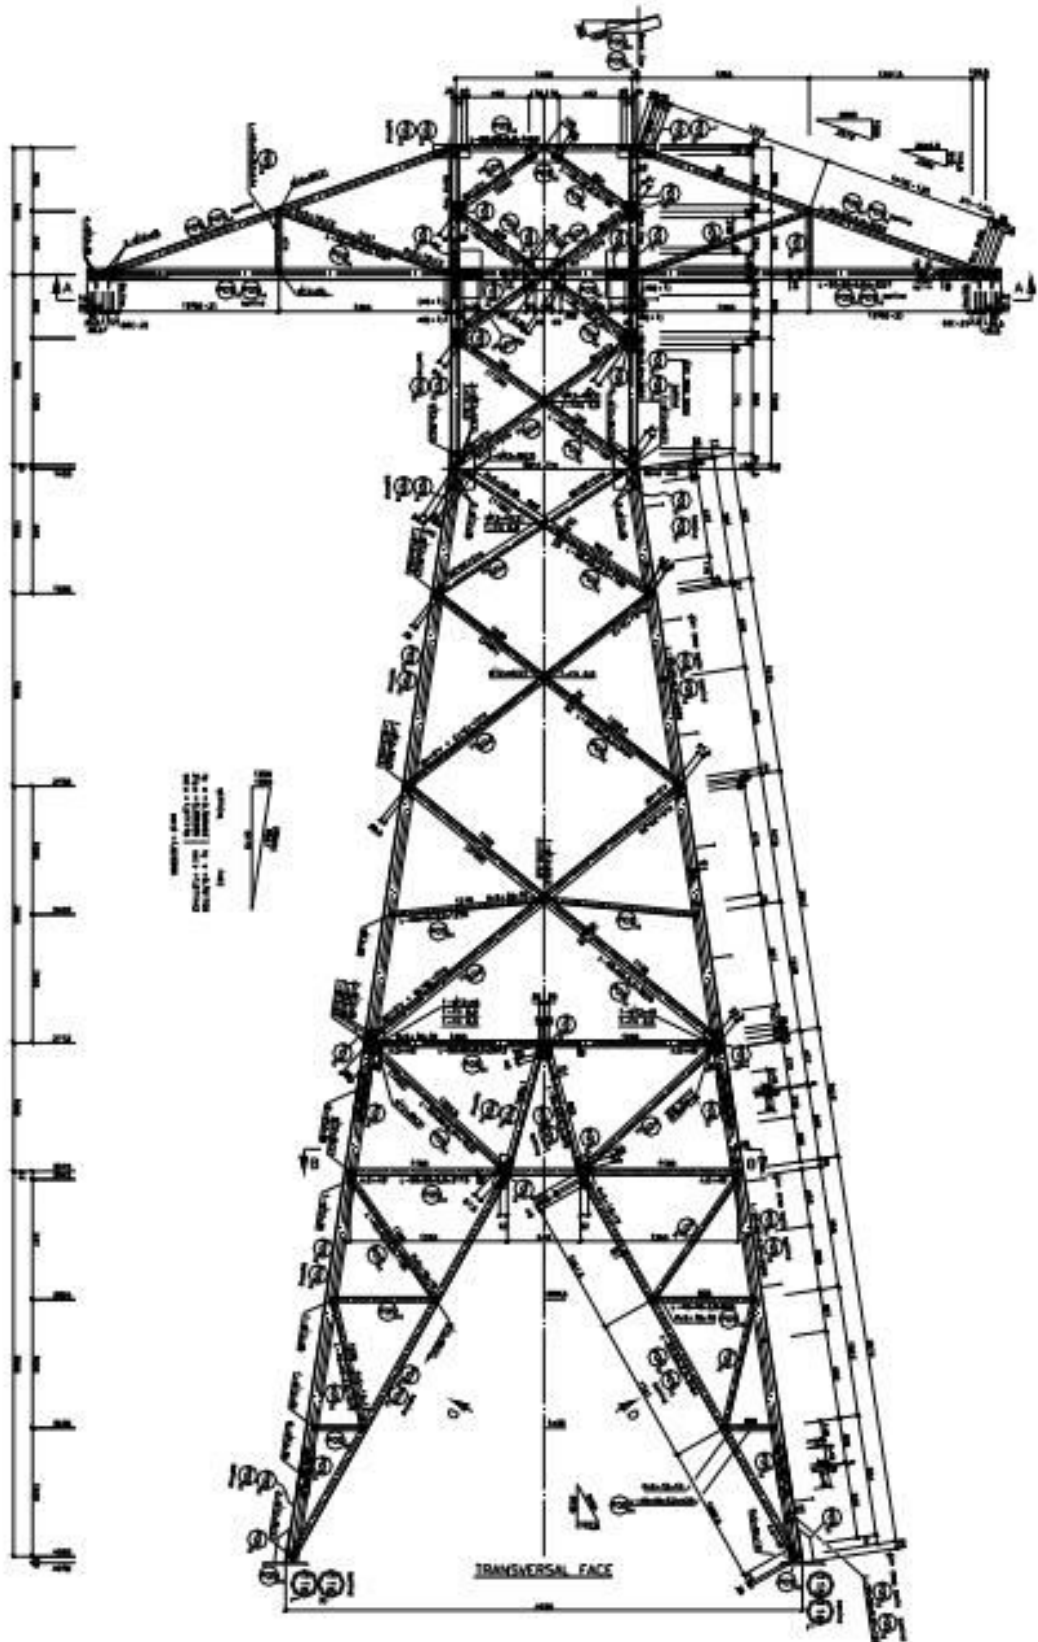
Estrutura "2A"- detalhamento da face transversal.
